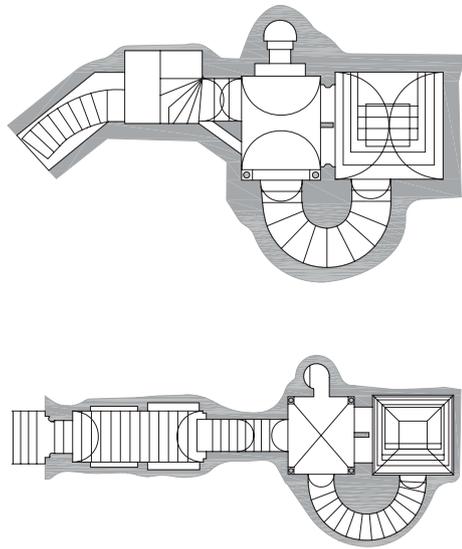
Grundrisse: oben Worms, unten Speyer (Bild rechts oben)
